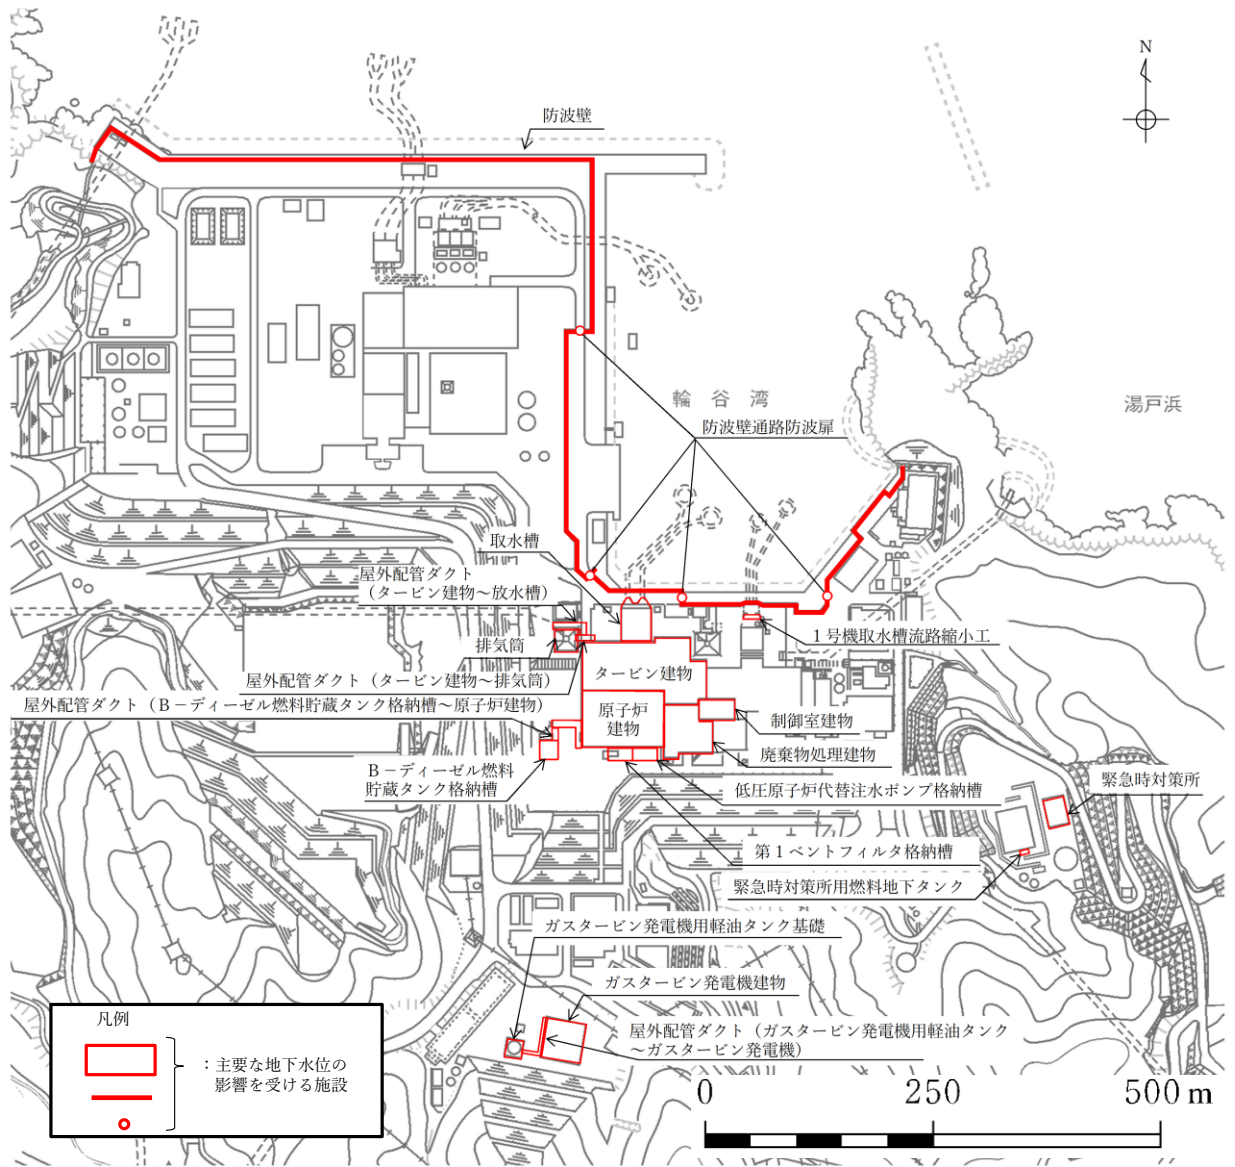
屋外の主要な地下水位の影響を受ける施設の配置図
